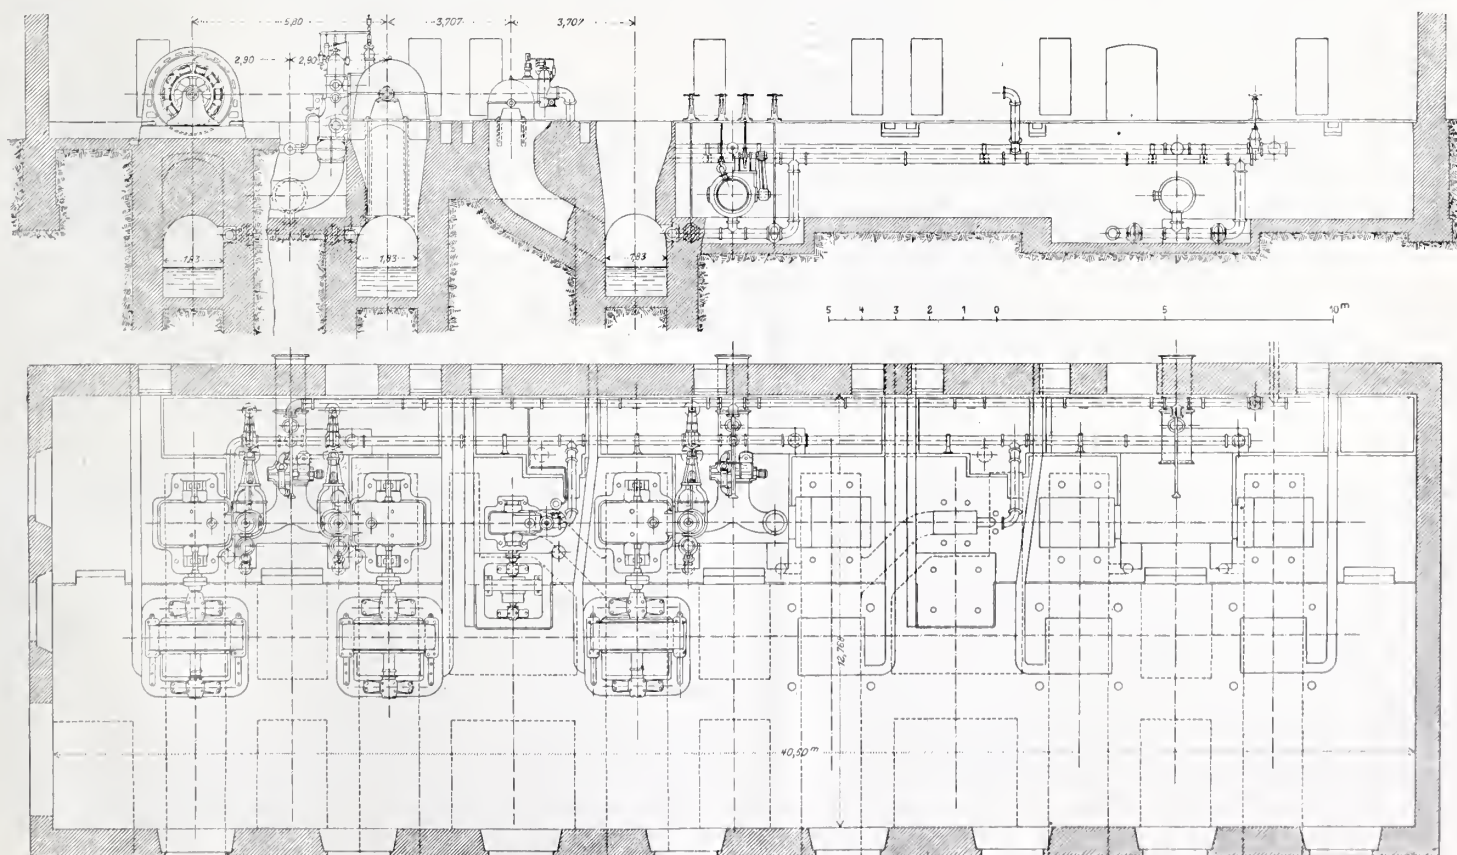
Grundriss und Längenschnitt des Maschinenhauses. — Masstab 1 : 225.
